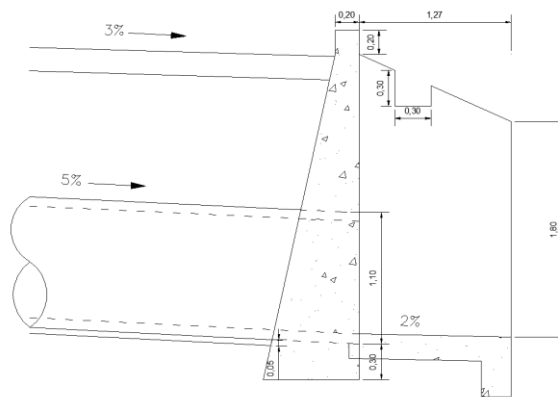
Sección transversal de la alcantarilla (Sección B-B)
